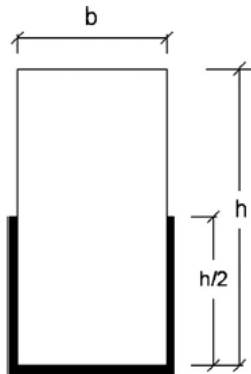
Solução construtiva adoptada por (García, et al., 2013) para reforço de vigas em madeira (vista da secção).
